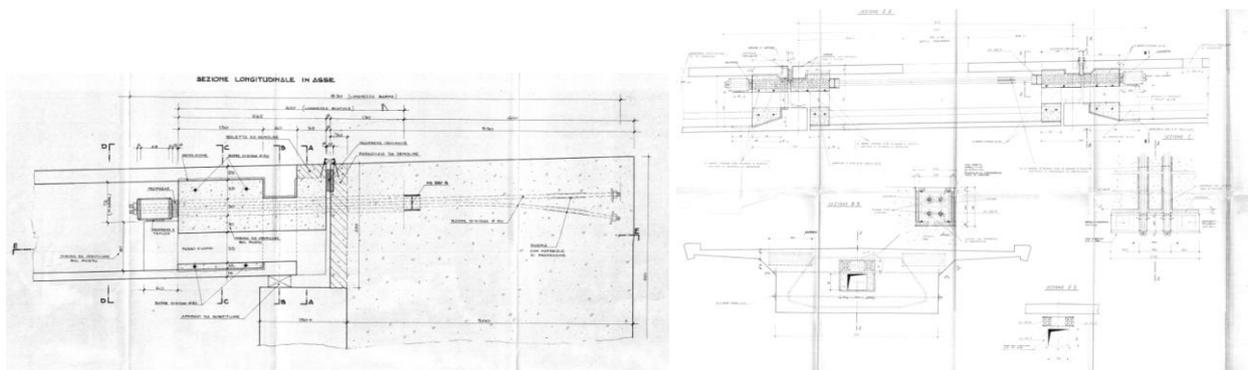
Collegamento spalla lato Celico a) Collegamento travi tampone b)
